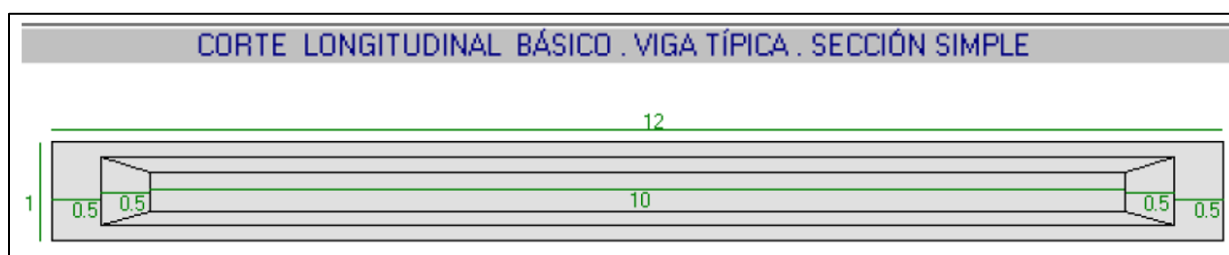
Esquema de la superestructura del puente de concreto postensado.
